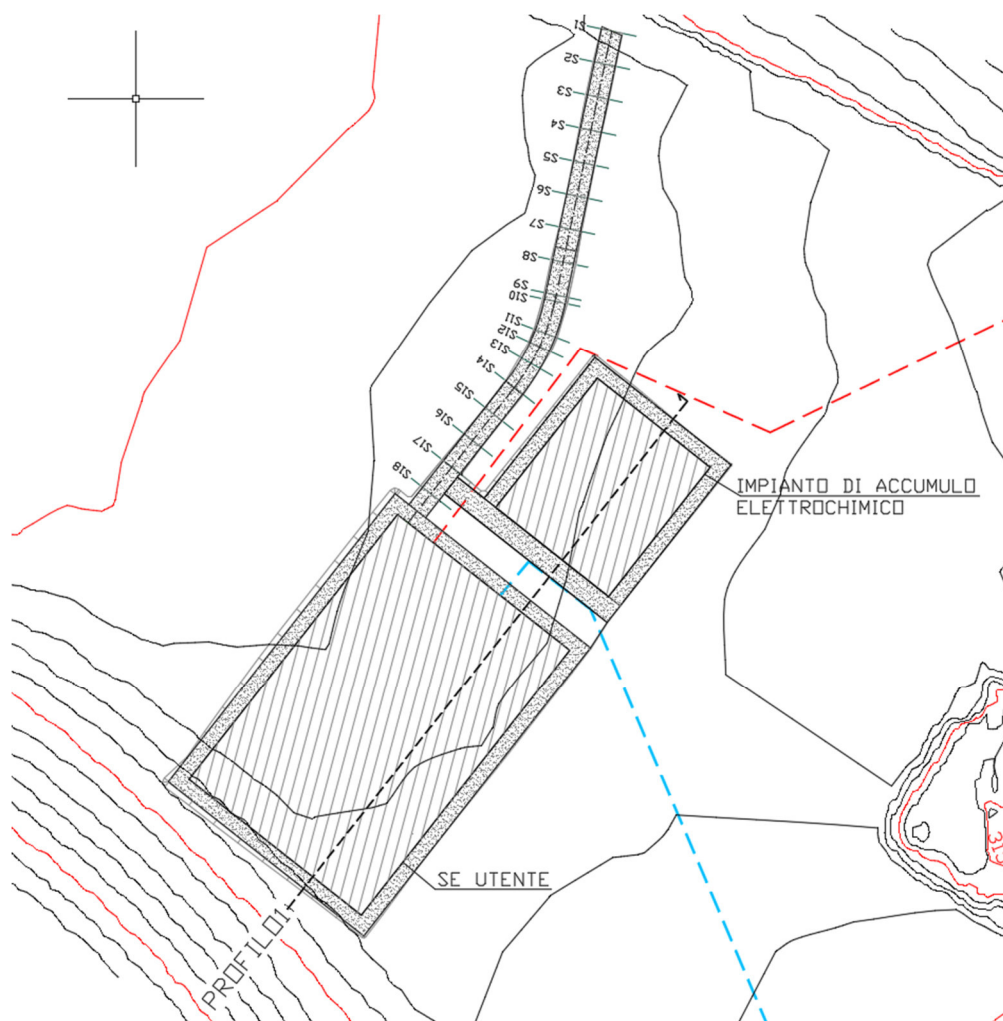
Stralcio planimetrico viabilità di accesso alla SE utente ed impianto di accumulo
